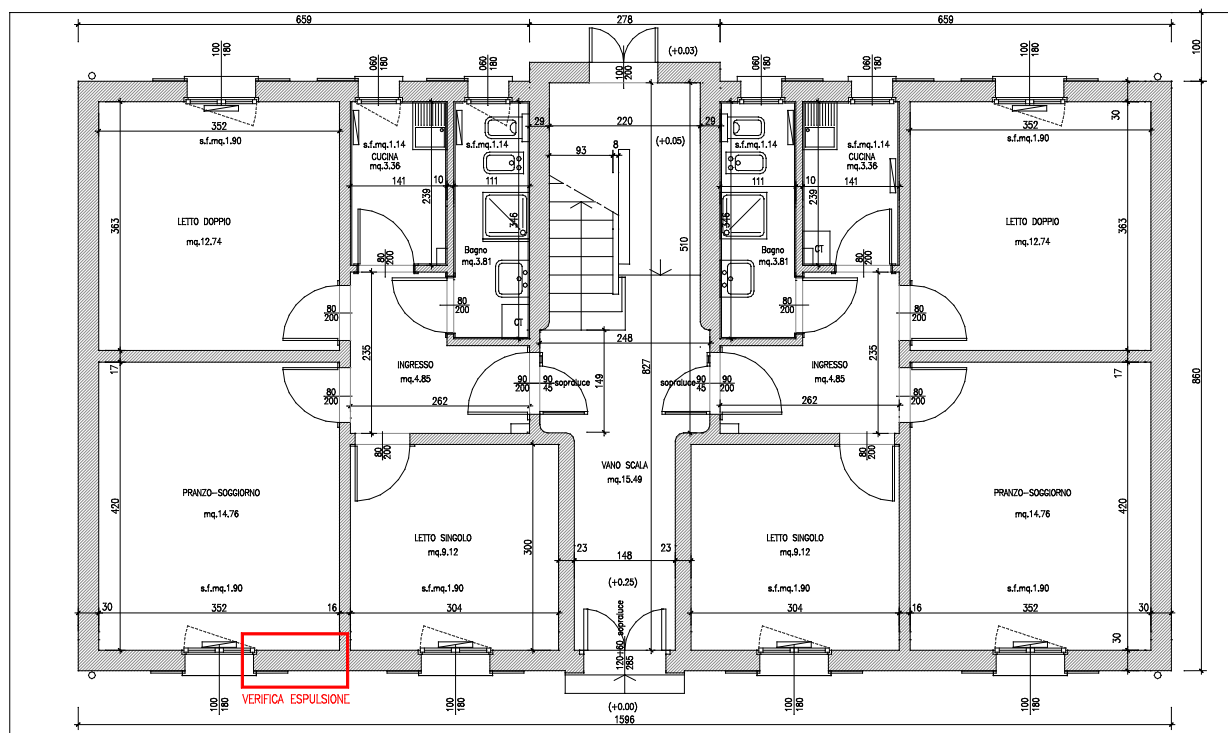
Palazzina B – PIANO TERRA – Individuazione della parete oggetto di verifica
